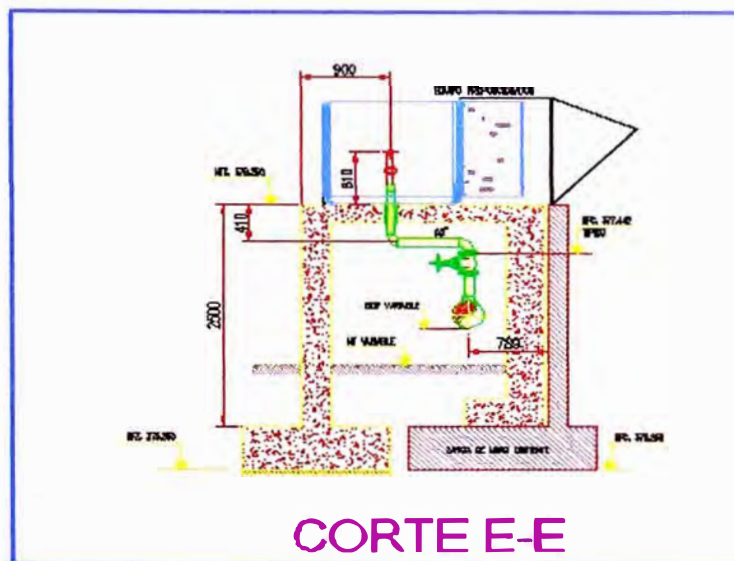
GENERADOR DE ESPUMA – Sobre Estructura Concreto
